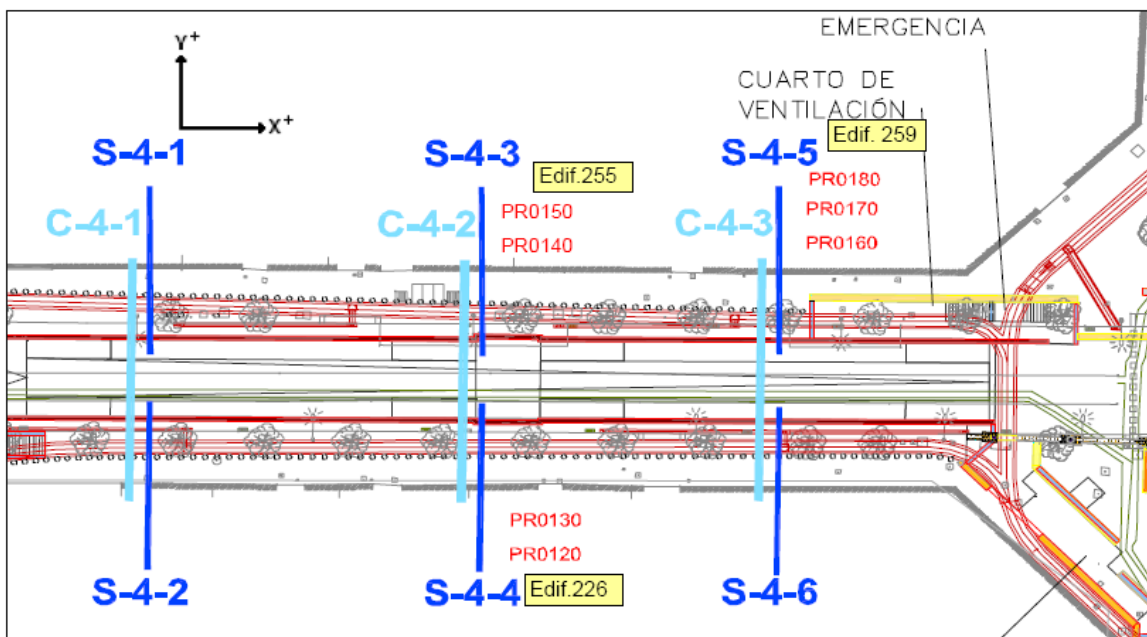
Planta de situación de la instrumentación. Prismas en edificios
